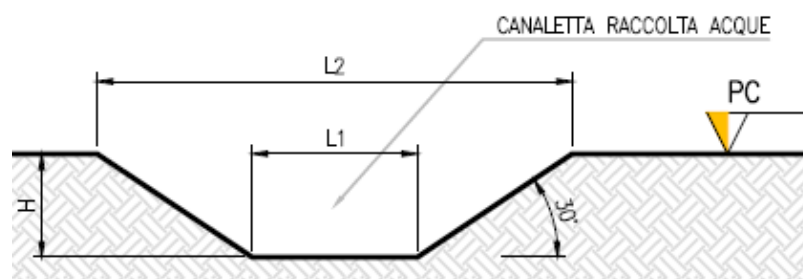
Sezione tipologica canaletta di drenaggio realizzata in scavo.
